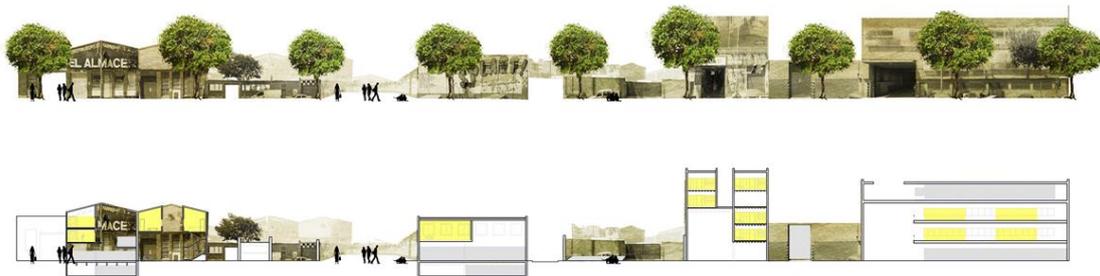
Beta Architecture. European 12: Barcelona: Viviendas-taller. Espacio público rodeado por viviendas taller.
